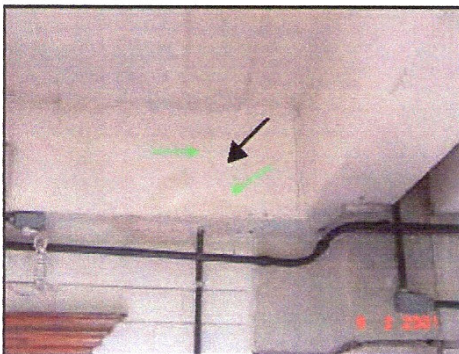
Fissura de cisalhamento ($F_i=2$)
